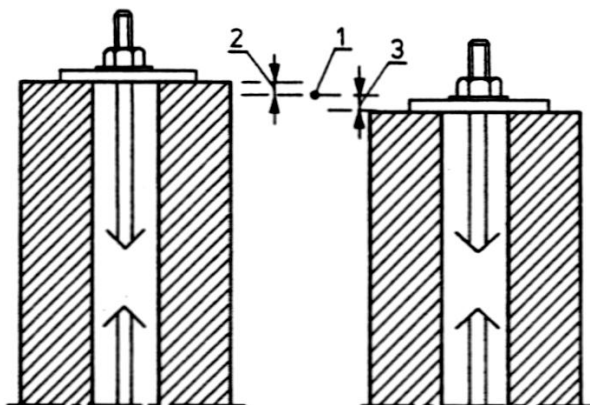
Возведение каменных стен с напрягаемой арматурой с помощью скользящих каналообразователей [2]
